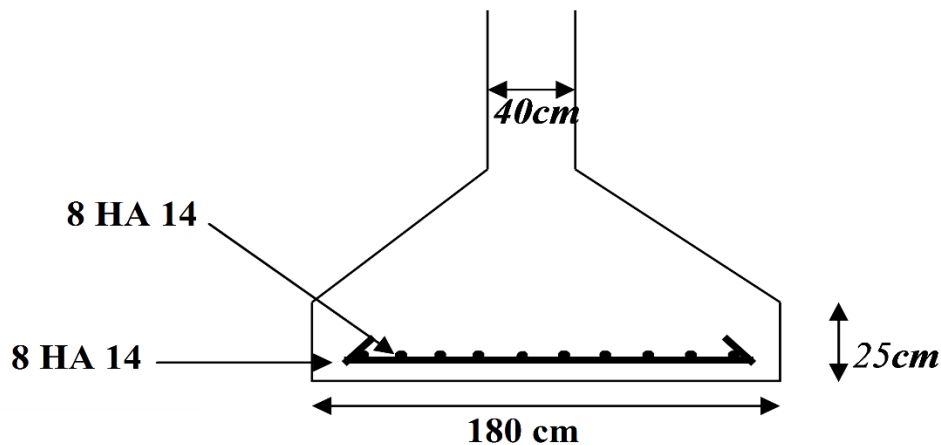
Disposition des armatures d'un semelle isolée
